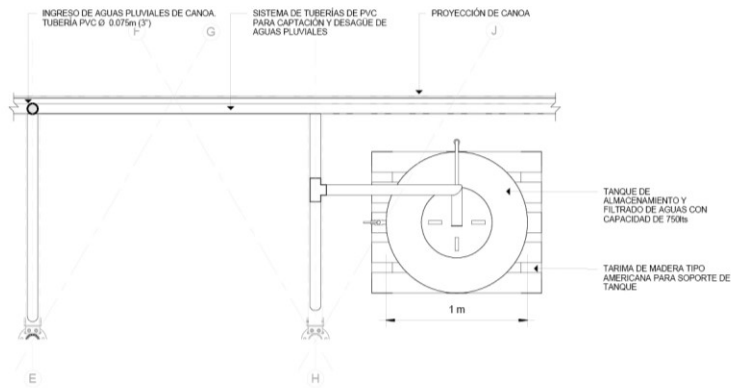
Lámina 07, planimetría de tipología B.<sup>316</sup>
